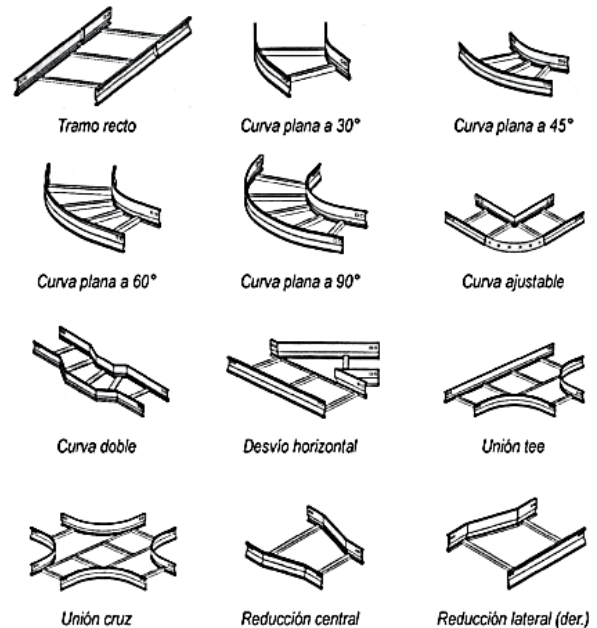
Tipos de bandejas utilizadas en instalaciones eléctricas
